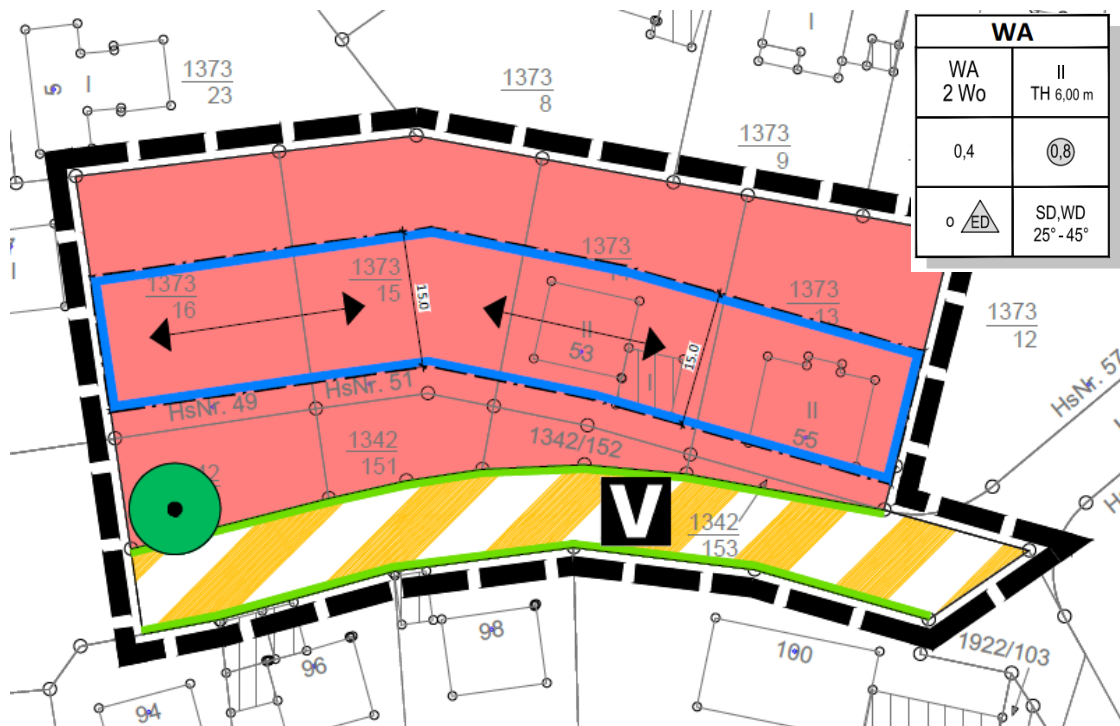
Bebauungsplan „Hirtenfeld II – 11. Änderung“
